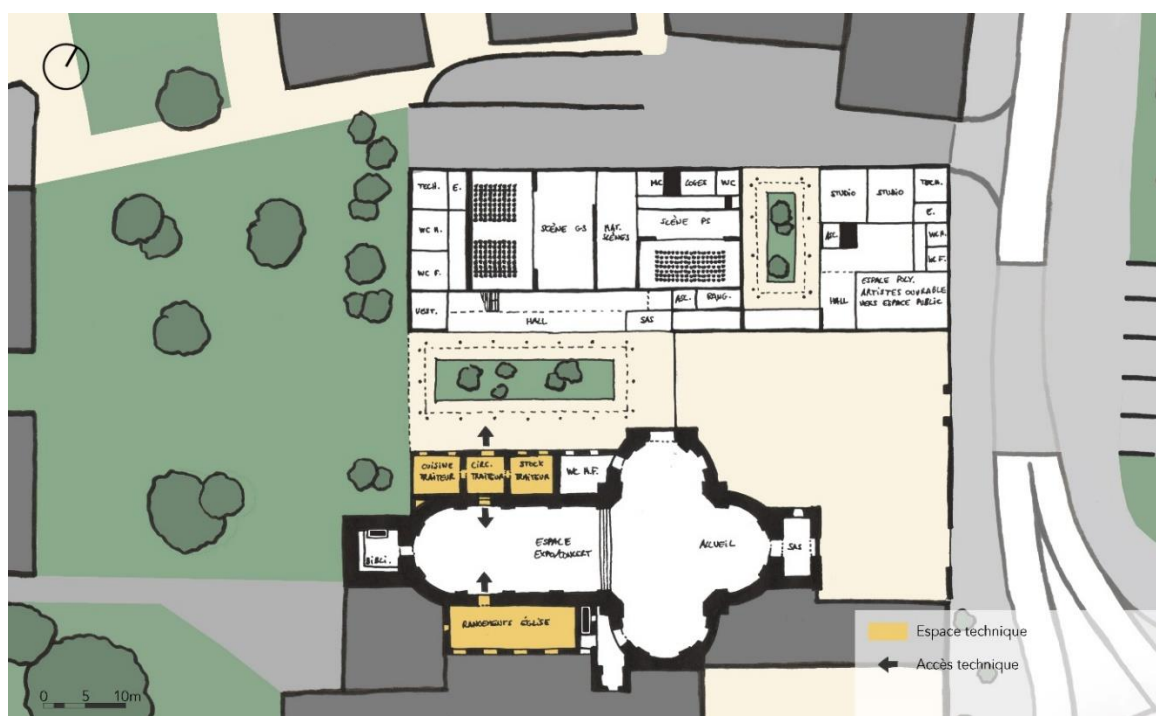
Distribution des locaux et accès techniques de l'église (fond de plan WalOnMap, 2016)
